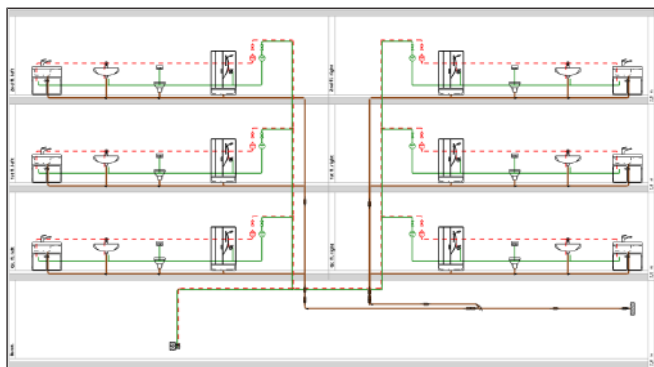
Planering av en tappvatteninstallation i ett strängschema
